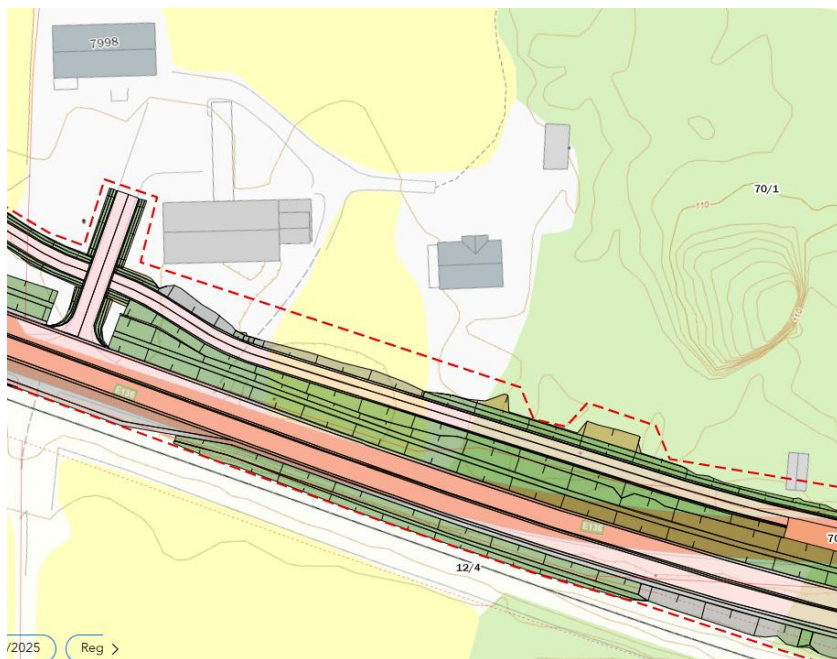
Planforslaget, vist med arealflater. Kilde AAV.
